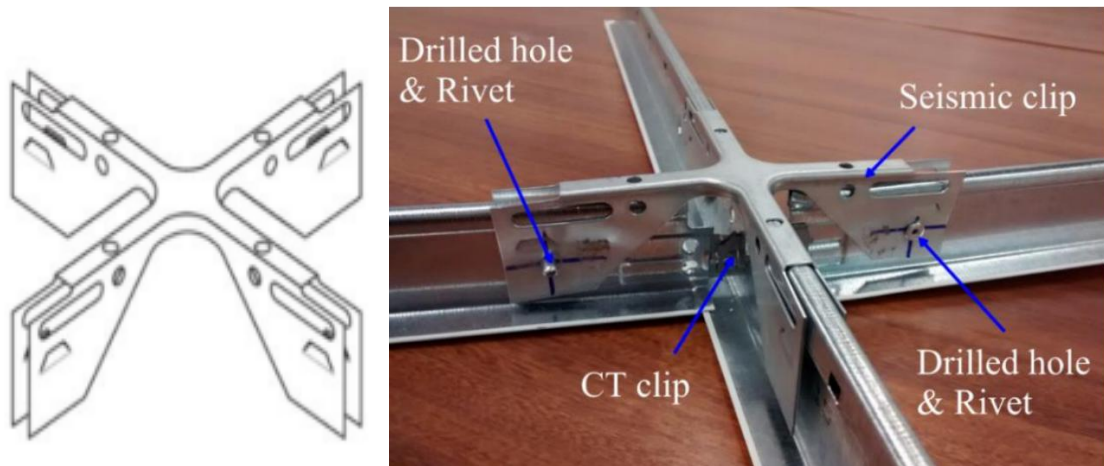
Disposição típica dos detalhes construtivos do teto suspenso utilizando técnica de reforço. Adaptado de [66]
